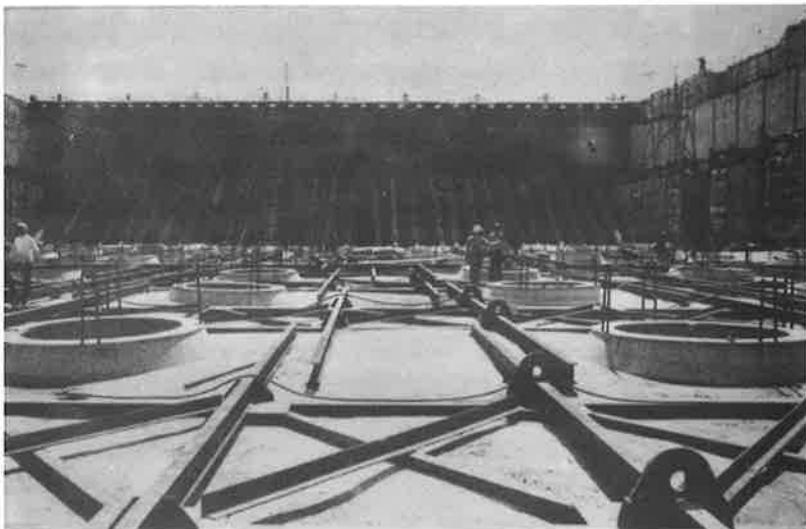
Particolare della platea di fondazione gettata in subacqueo : si notino le estremità superiori dei tralicci emergenti dal getto.
